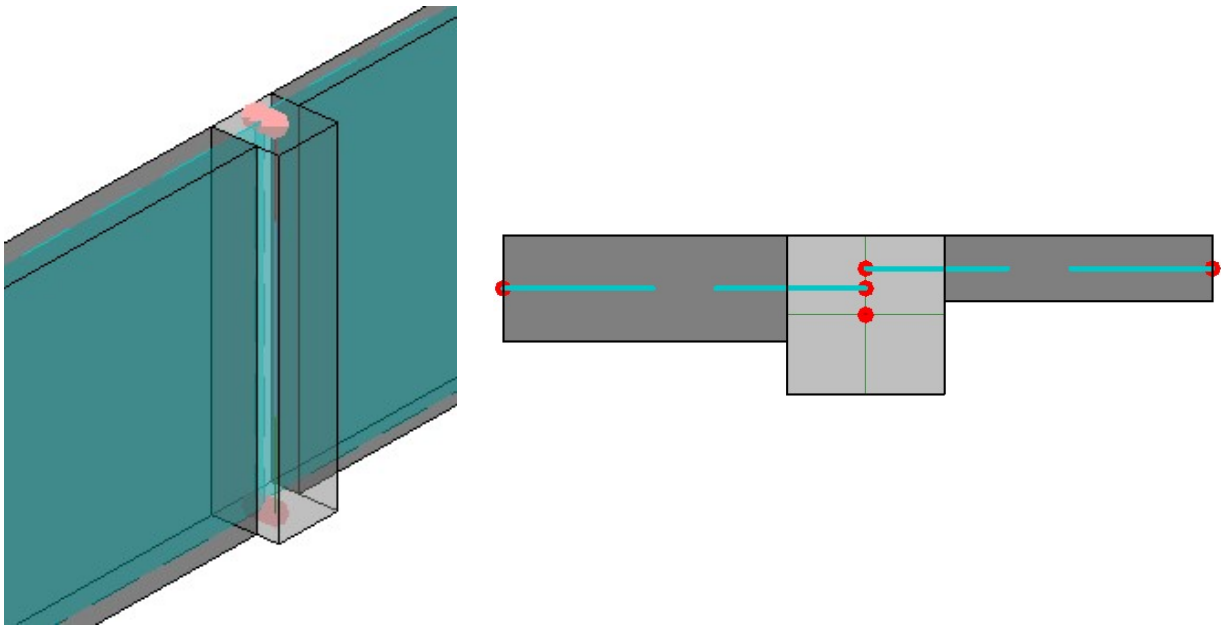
Vigas e pilares alinhados por autodetecção.
